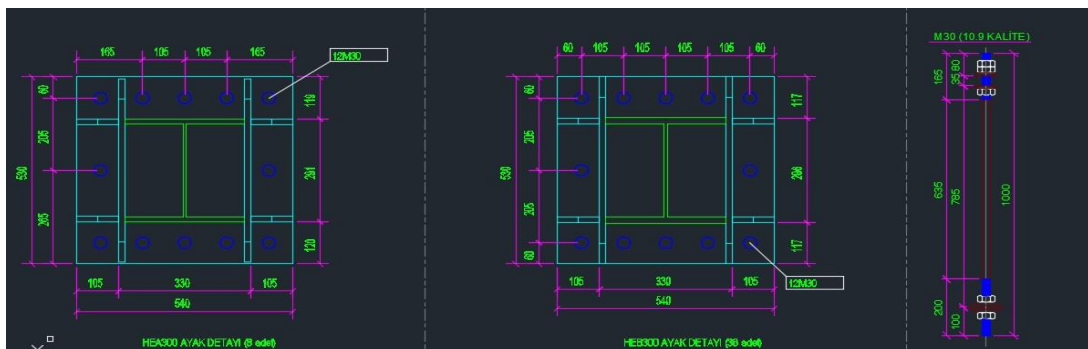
Örnek Proje-1 temel demir detayı örnek kiriş 2. Bölüm (Candan Mühendislik)
